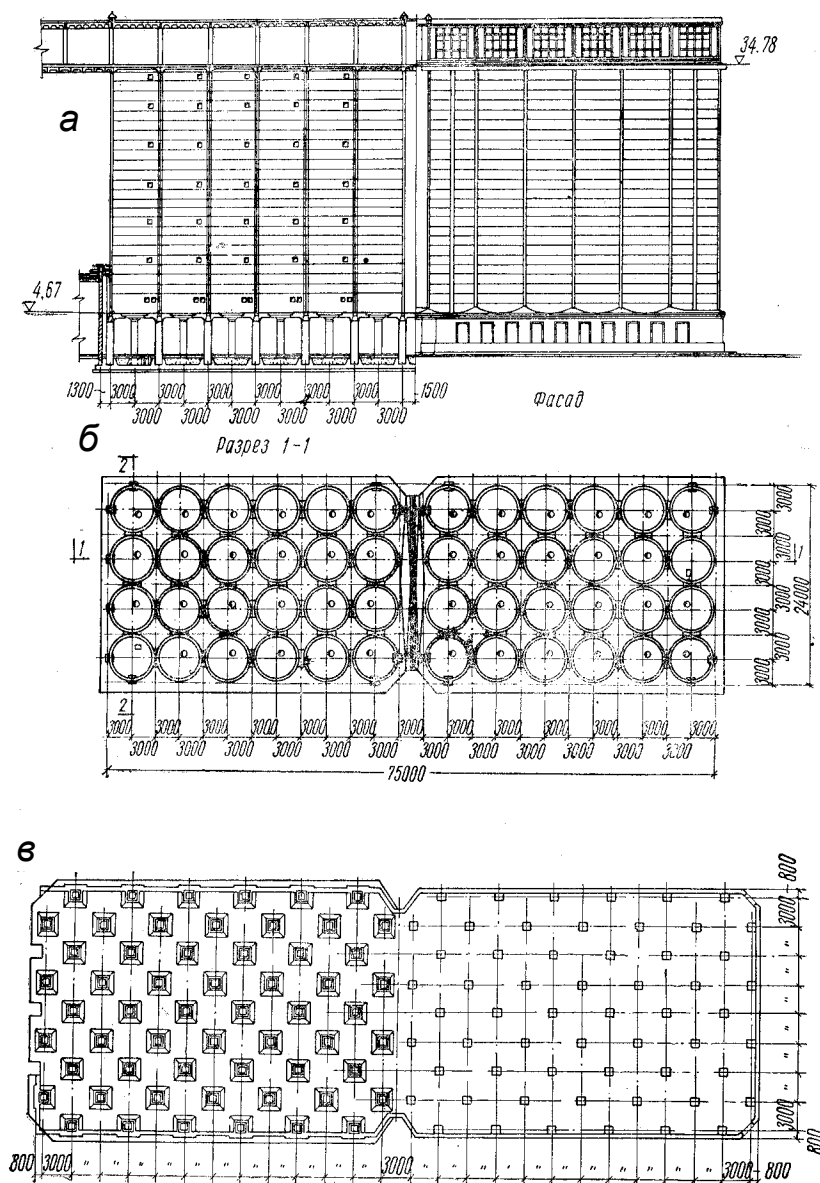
Силосный корпус, собираемый из железобетонных колец: а- фасад и продольный разрез; б- план; в- план подсилосного этажа (справа) и фундаментной плиты (слева)
